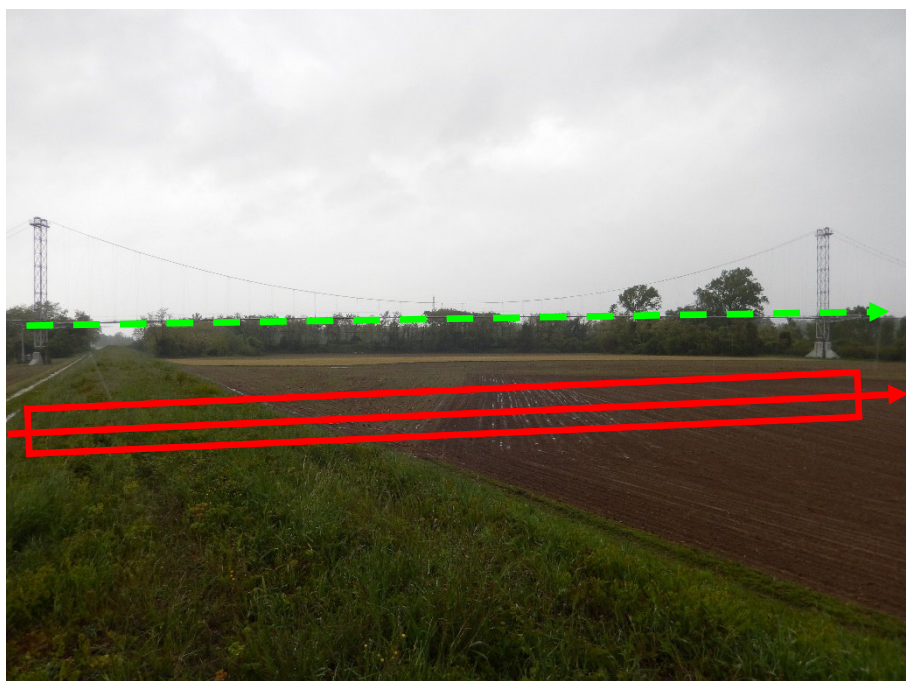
ATTRAVERSAMENTO AEREO MET. DA DISMETTERE E NUOVO ATTAVERSAMENTO IN TRENCHLESS IN PROGETTO
